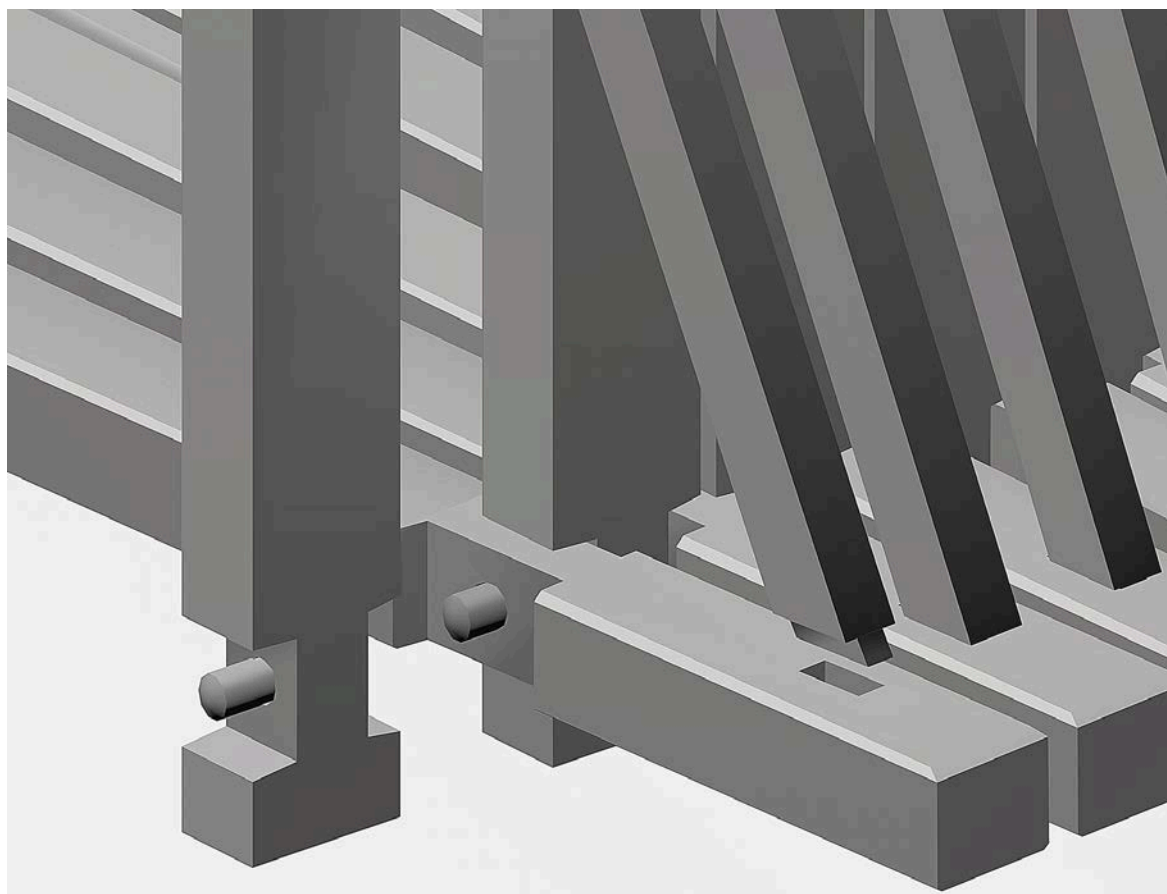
Restitution 3D de la pile. Détail sur l'assemblage madriers/poteaux. Dessin : Marion Berti.
